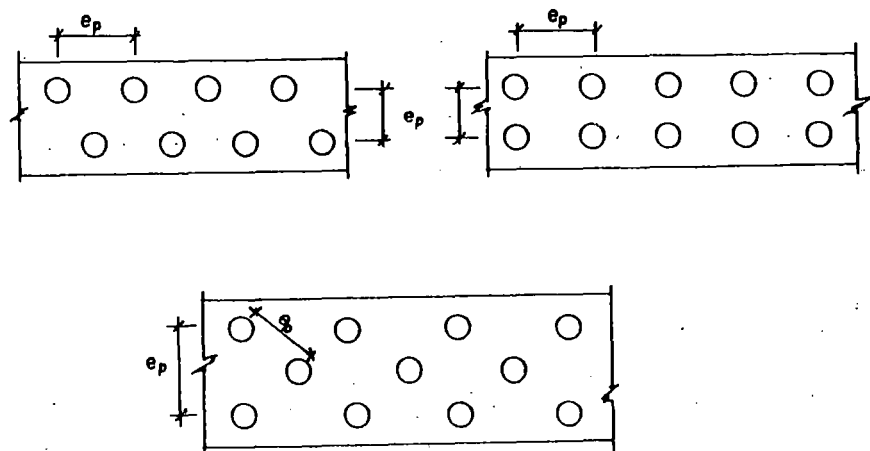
Disposición de pilotes en muros de cimentación.
